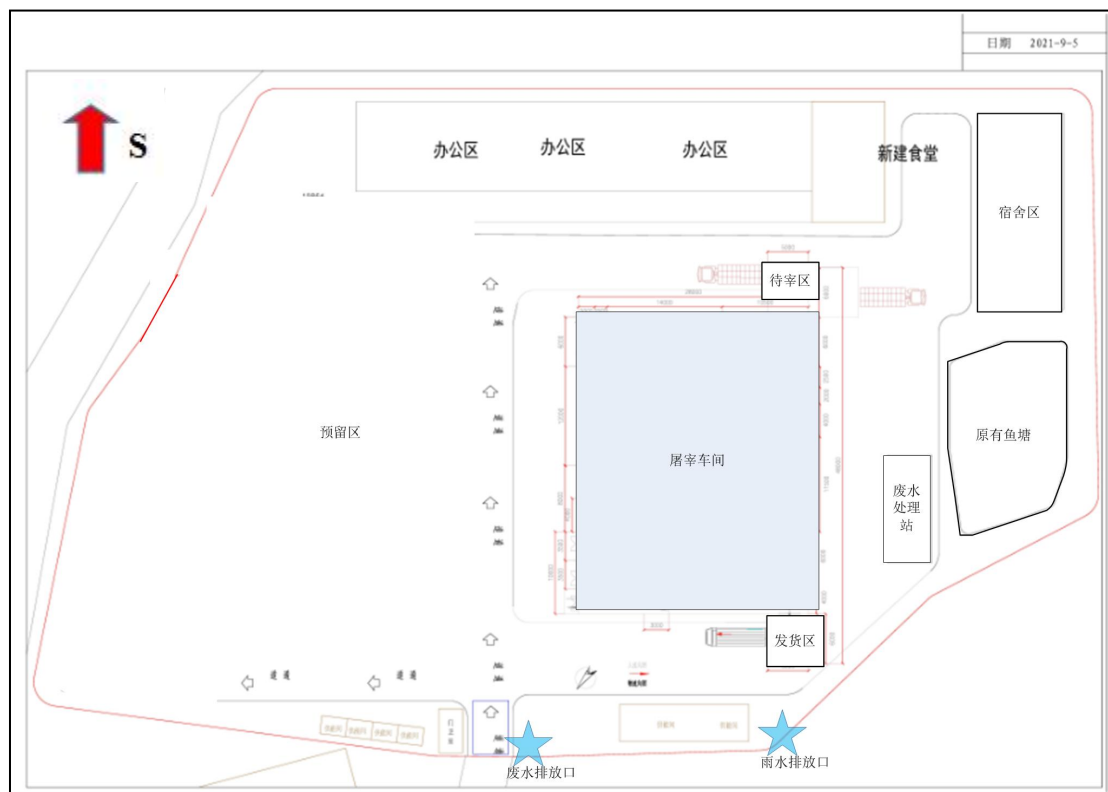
(2) 实际建设的现有项目总平面布置图
